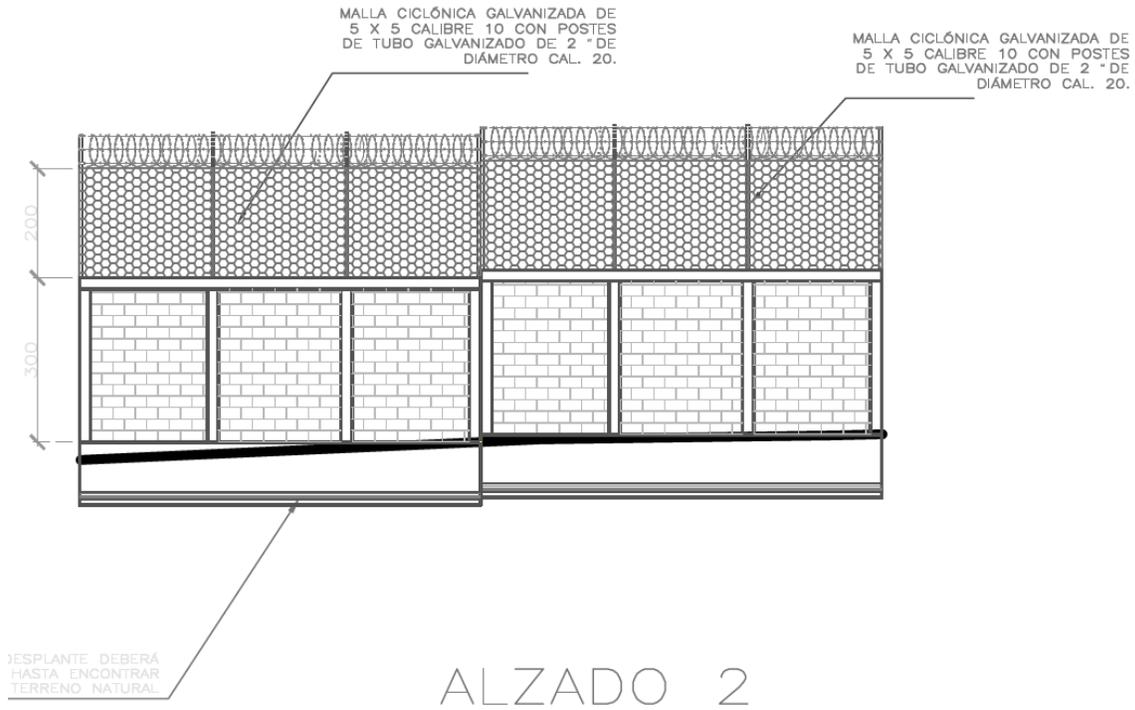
Alzado tramo 2 de barda perimetral proyectado.
